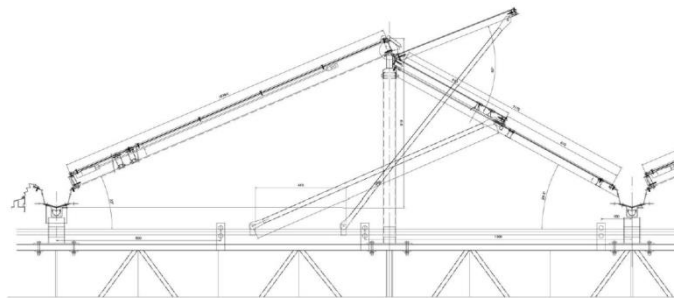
Plan de coupe : Toiture serres et système d'aération pan Nord
